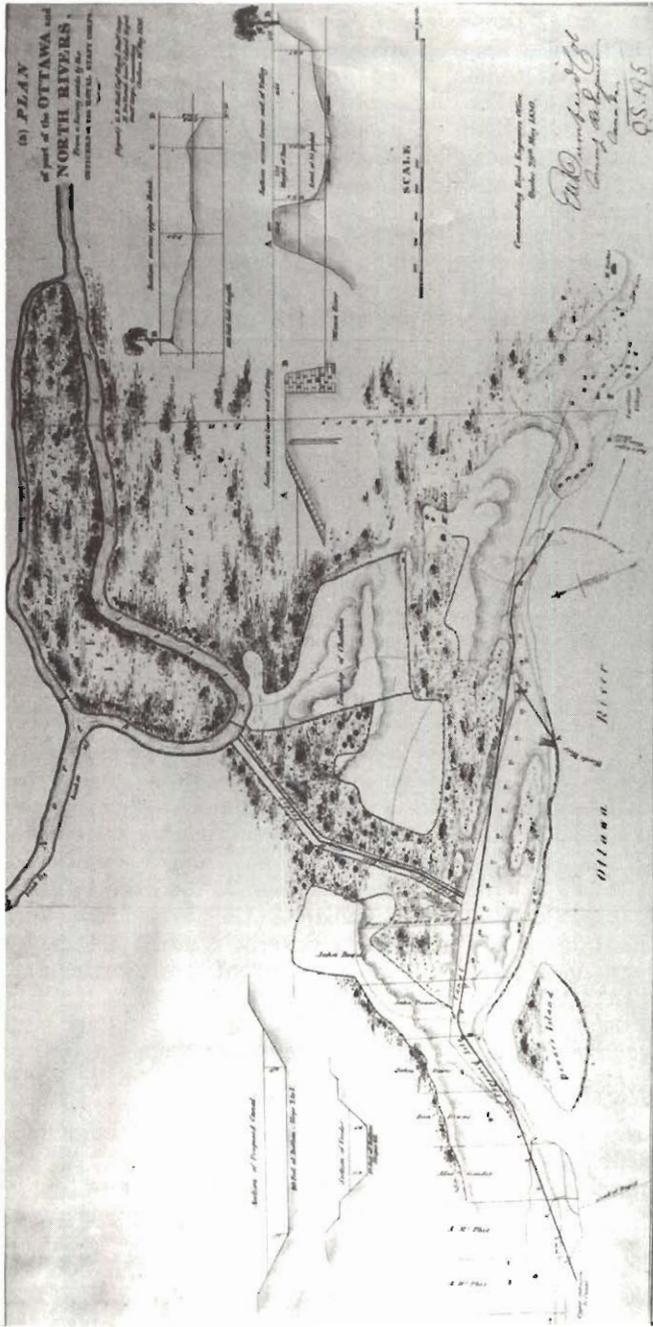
Emplacement du site proposé par le lieutenant-colonel H. Du Vernet pour la construction du canal militaire de Carillon, le 29 mai 1830. Le plan indique la position du canal d'alimentation ainsi que les deux petits barrages de pierre érigés sur la rivière du Nord. (Archives publiques Canada.)
